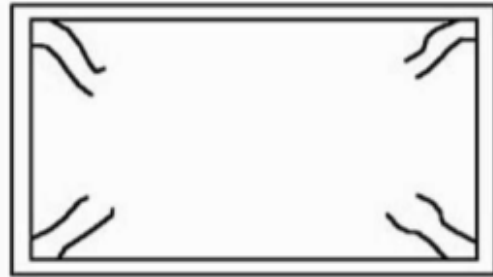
Fissuração por deficiência de armaduras para combater aos momentos volventes, na face inferior da laje
